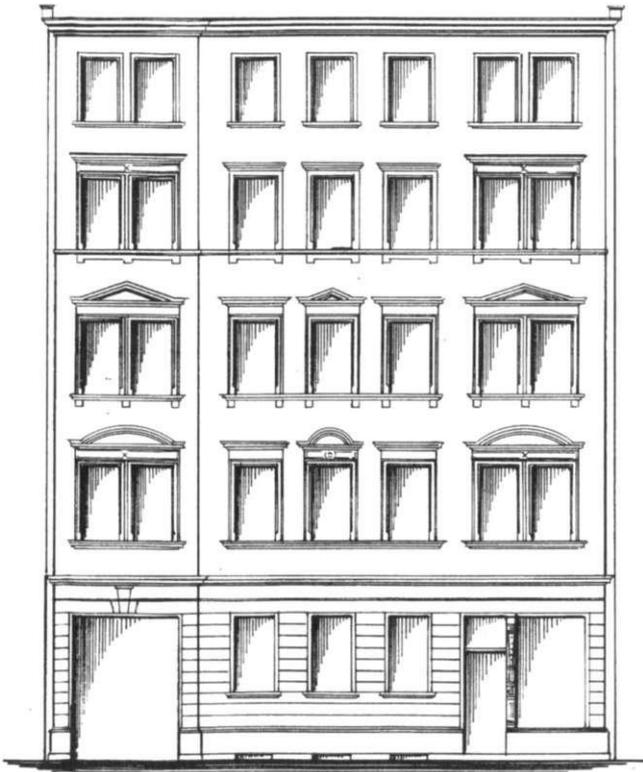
Immermannstraße 8, Fassadenzeichnung
